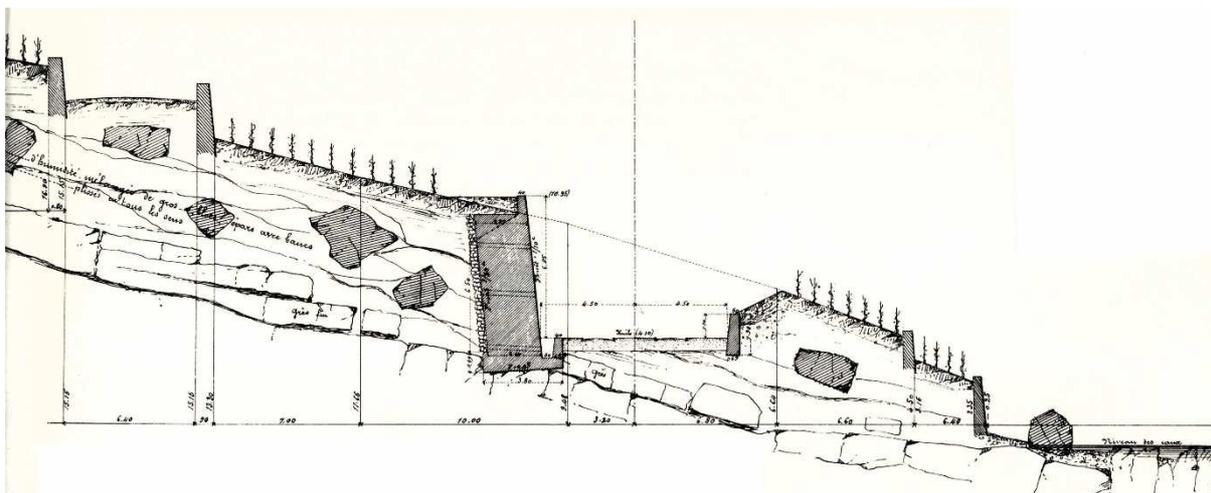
Profil établi pour la construction de la ligne ferroviaire Lausanne-Vevey, lieu précis non connu. L'étagement est bien lisible, depuis la droite : lac, parapet protégeant contre les eaux, mur de terrasse de vigne, parapet, chemin de fer, mur de soutènement, parapet, route, parapet.
